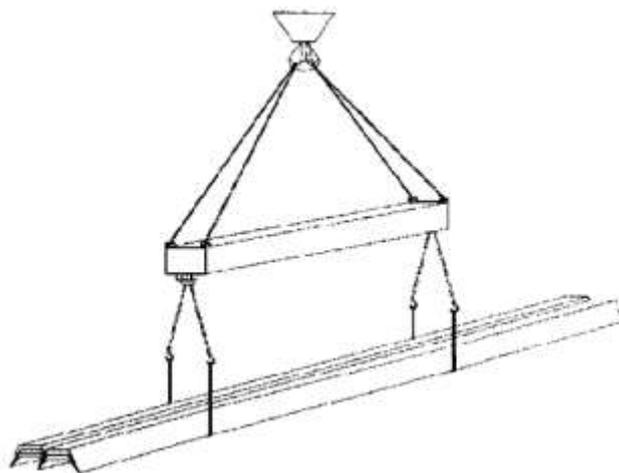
Перегрузка металлического шпунта в пачках при помощи распорной траверсы с комплектом стропов
